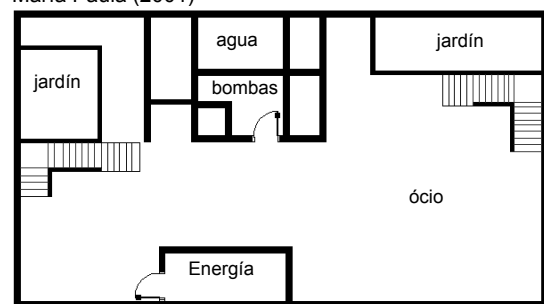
Planta configurada del subsuelo del Edificio María Paula (1940)
